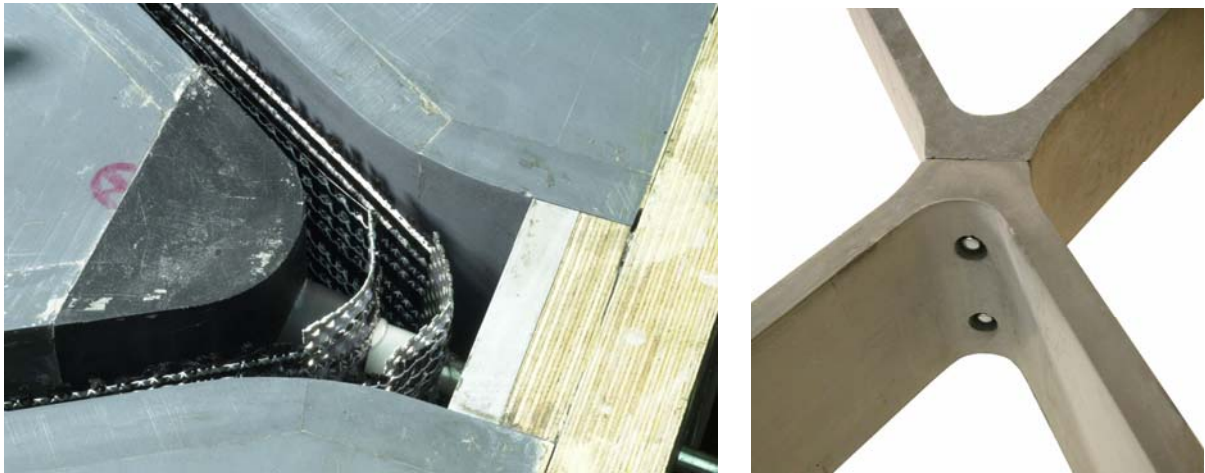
Schalung mit Bewehrungsführung und Einbauteilen (links); Bolzenverbindung in den Knotenpunkten (rechts) (Quelle: bauko2, RWTH Aachen)
